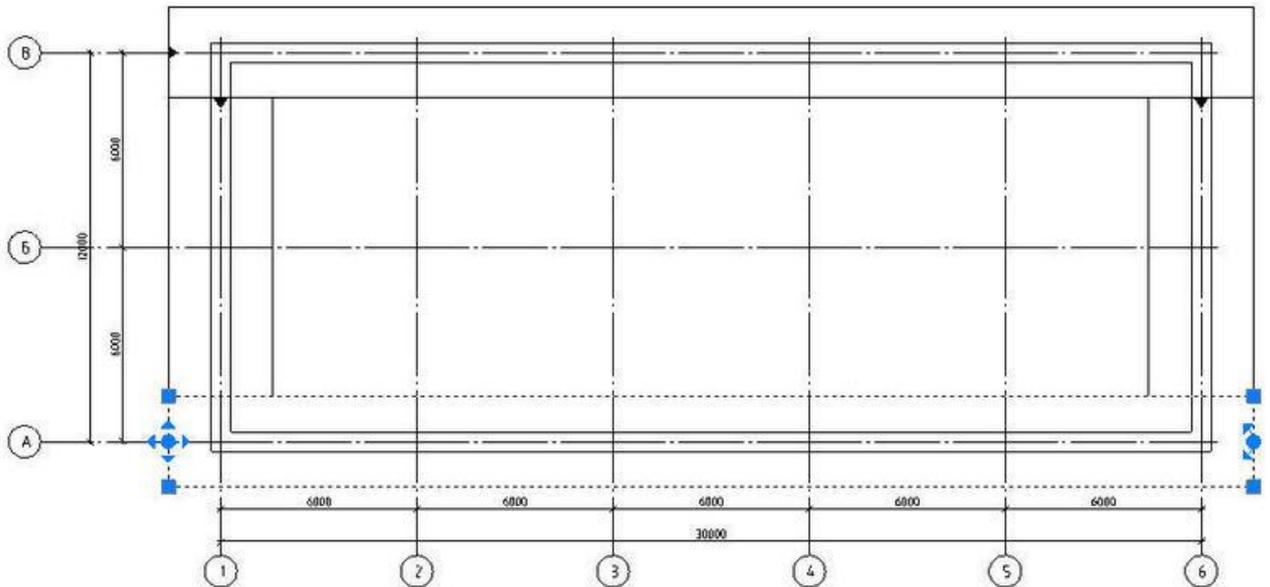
Расчет сборного ленточного фундамента. Схема фундамента
